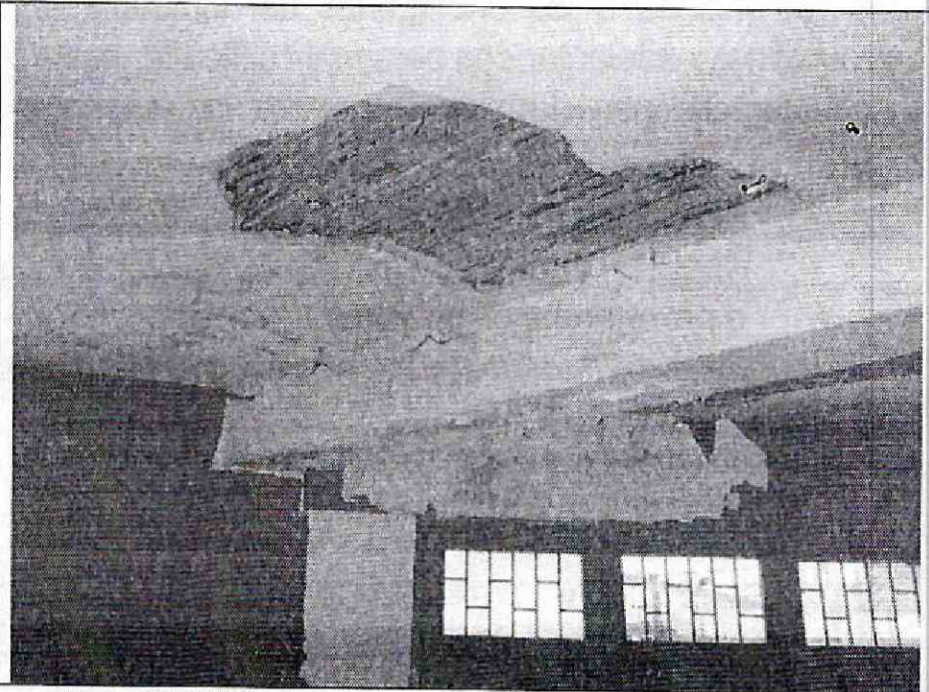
Vista interior primer piso. Desprendimiento de mortero y/o recubrimiento cielo raso, humedades y eflorescencias
